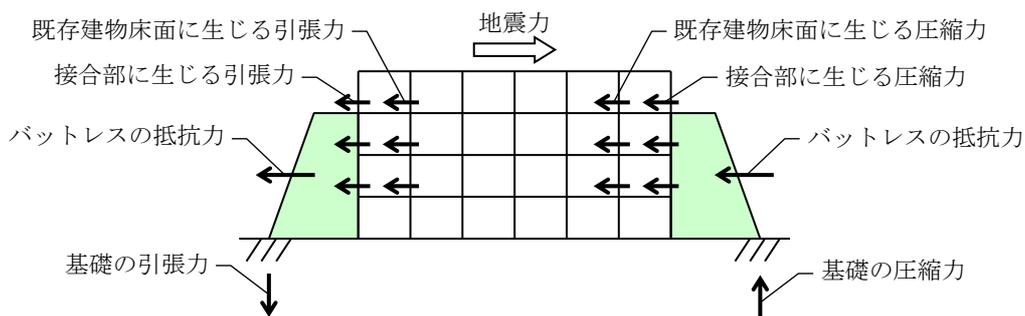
既存建物およびバットレス周辺に生じる応力
